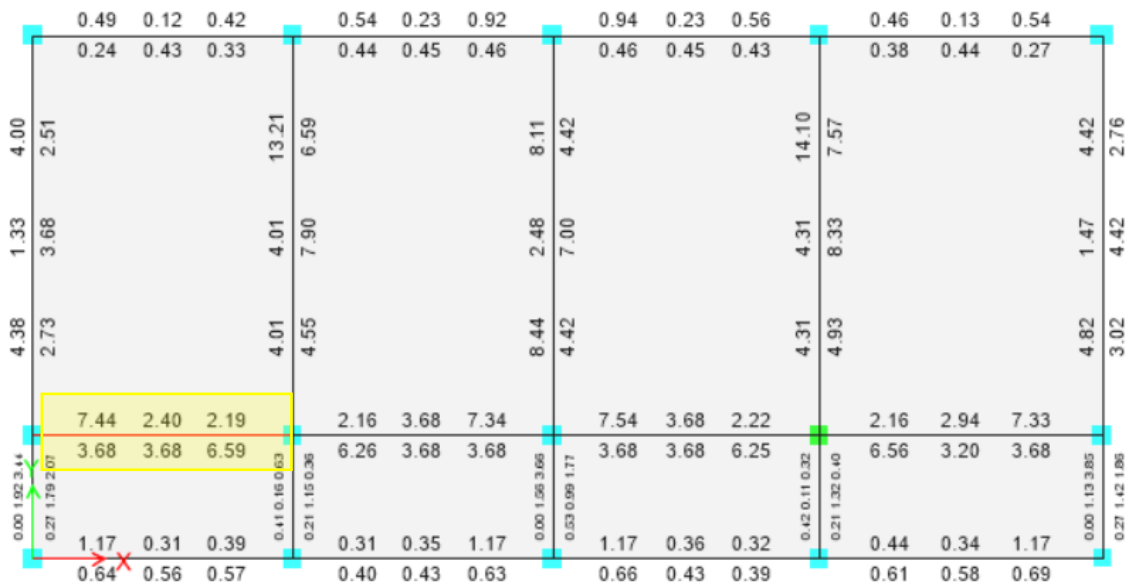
Vista en planta del primer nivel de vigas y columnas del Pabellón B
